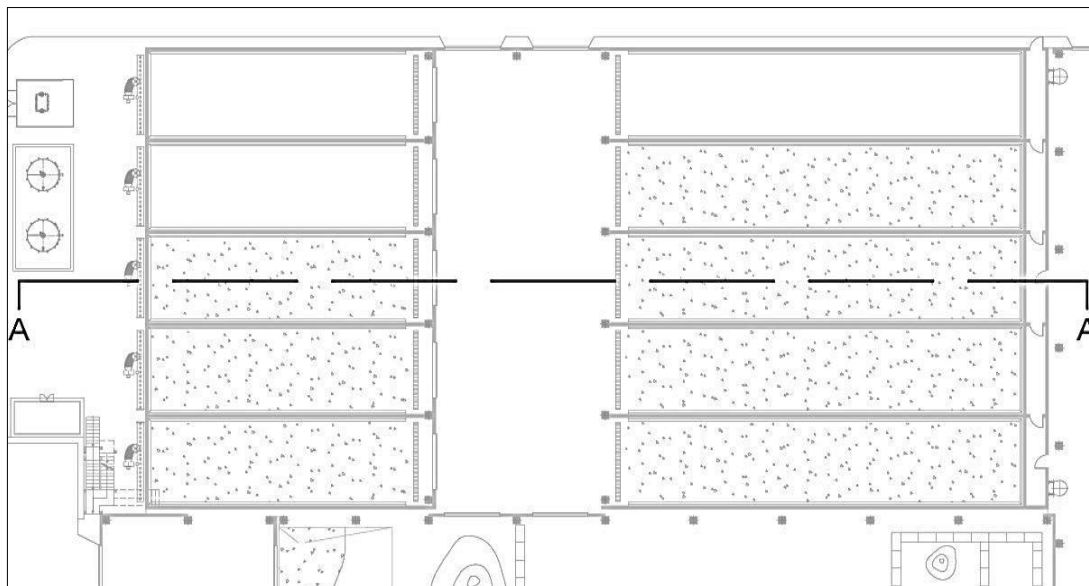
PLANIMETRIA CORPO B – BIOCELLE, TUNNEL E MATURAZIONE PRIMARIA
